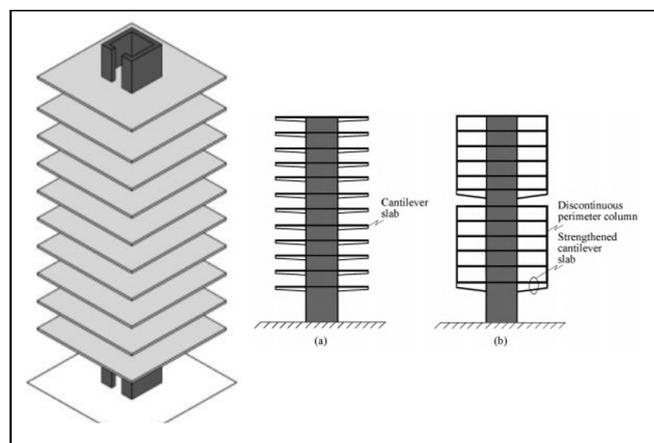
dalles cantilever et dalles cantilever renforcées
